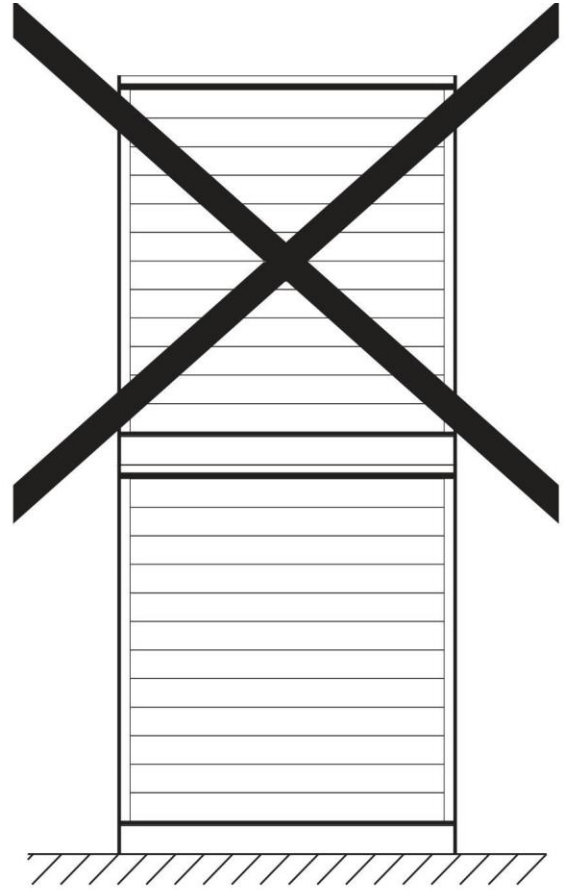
Запрещенное складирование панелей на строительной площадке.
